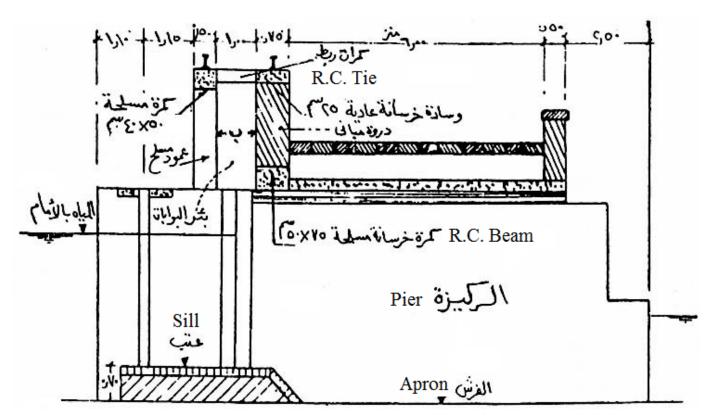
تفصيلات منشأ رفع البوابات من الخرسانة المسلحة
